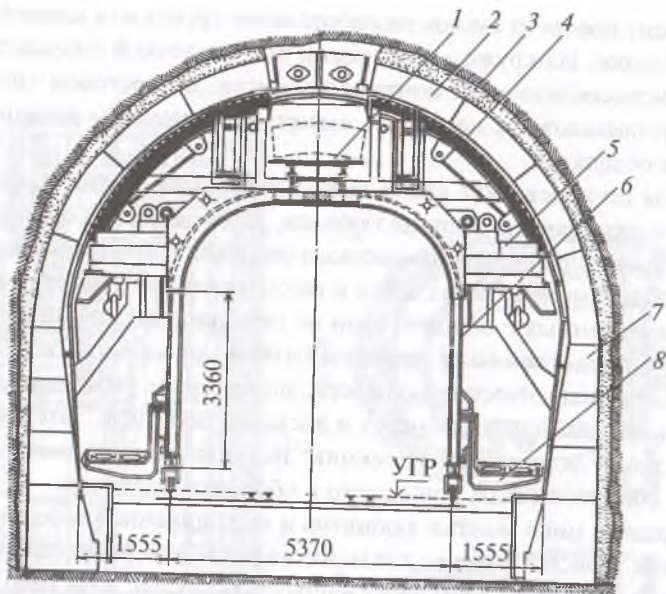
Механизированный комплекс для переустройства обделки двухпутного тоннеля:
